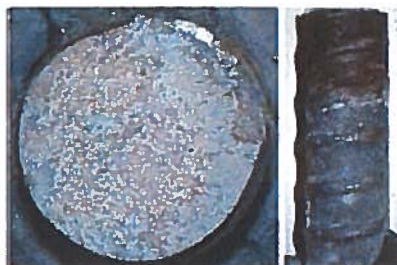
Aspeto geral duma superfície de fratura e pormenor da corrosão na superfície da barra de aço.
